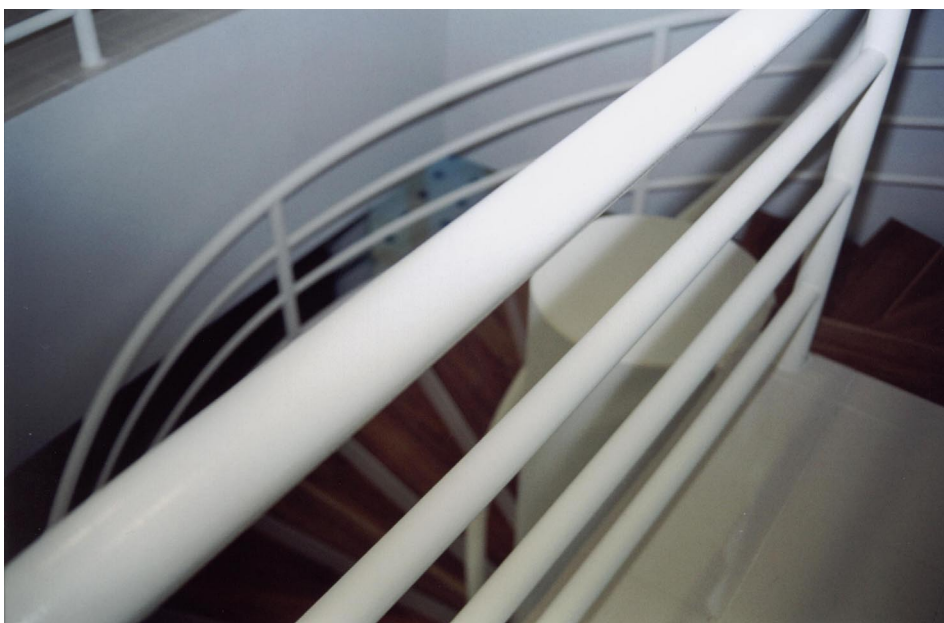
Vista interna do Edifício Sede: detalhe da escada de acesso ao segundo pavimento
